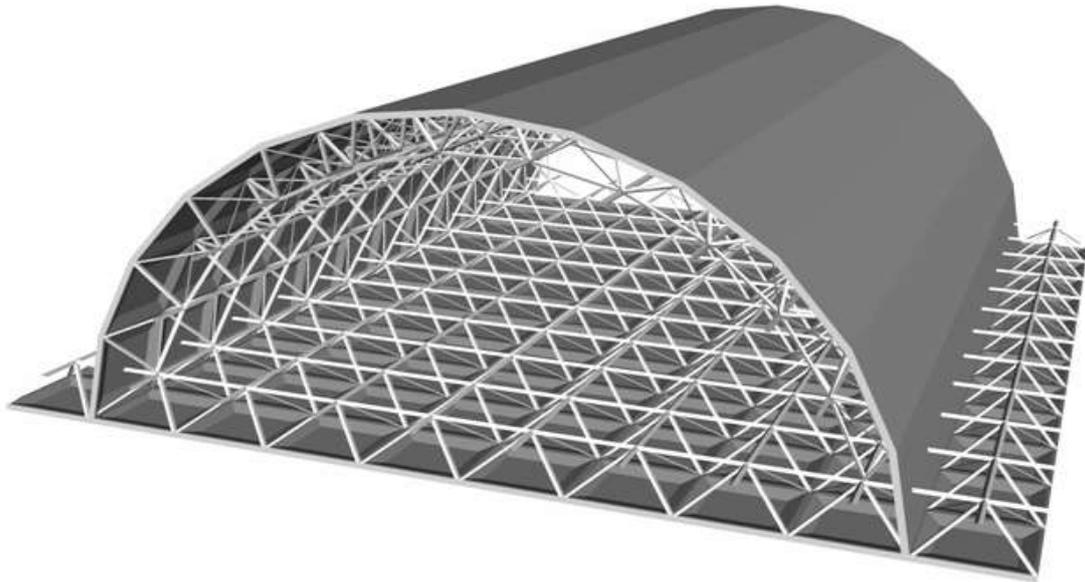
Расчетная схема здания, объединенного с фундаментной платформой
